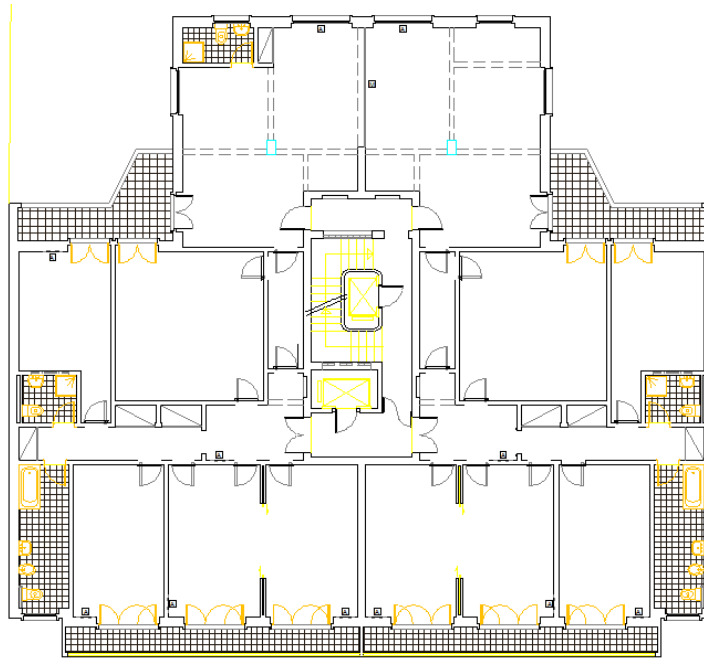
Planta tipo do edifício existente – Pisos superiores
